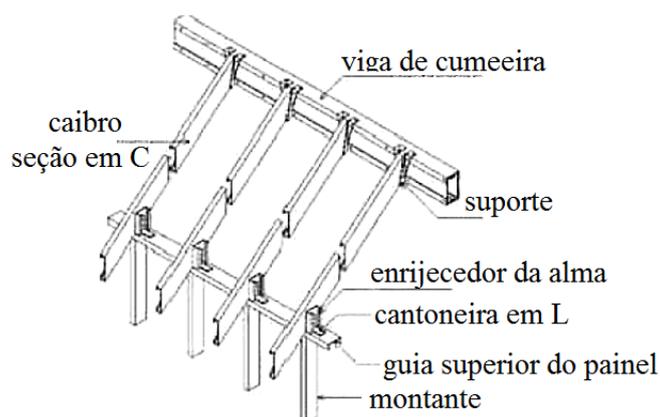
Detalhes de cobertura inclinada por painéis em LSF (NASFA, 2000)
